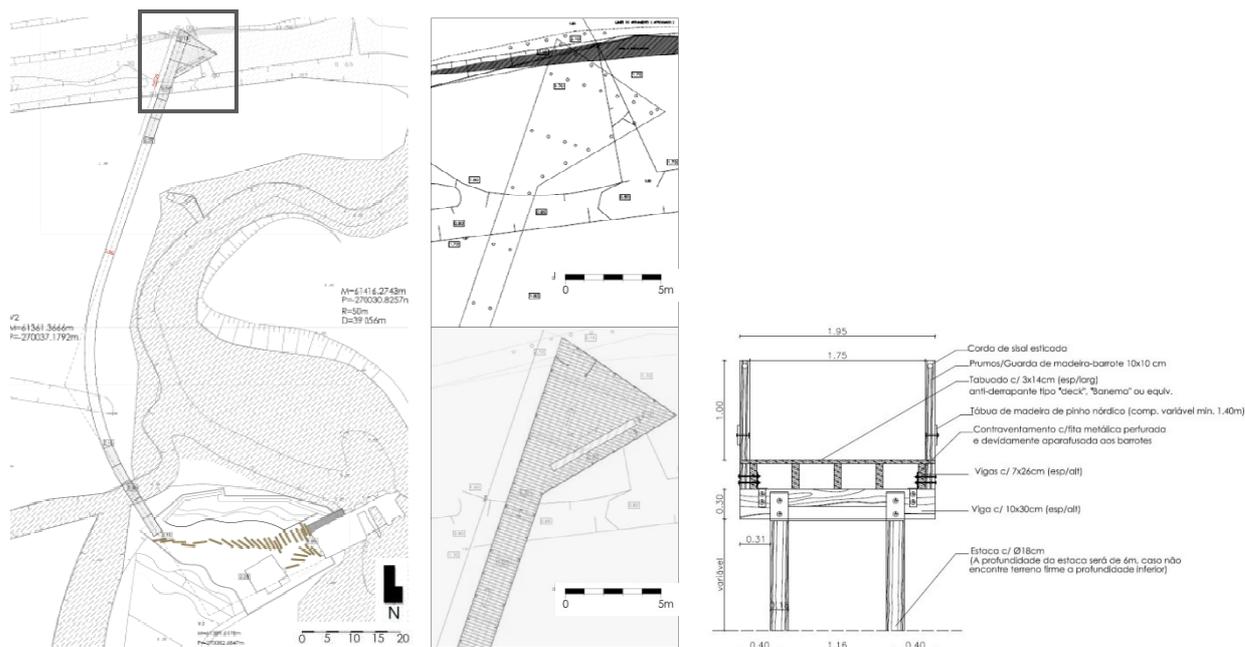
À esquerda, planta de implantação dos passadiços e percursos através de geo-referenciação; ao centro: pormenores da plataforma (em cima – implantação das estacas, em baixo – estrado, guardas e banco) e, à direita, corte do passadiço sobrelevado. (desenhos base à esc. 1/1000, 1/100 e 1/20).
